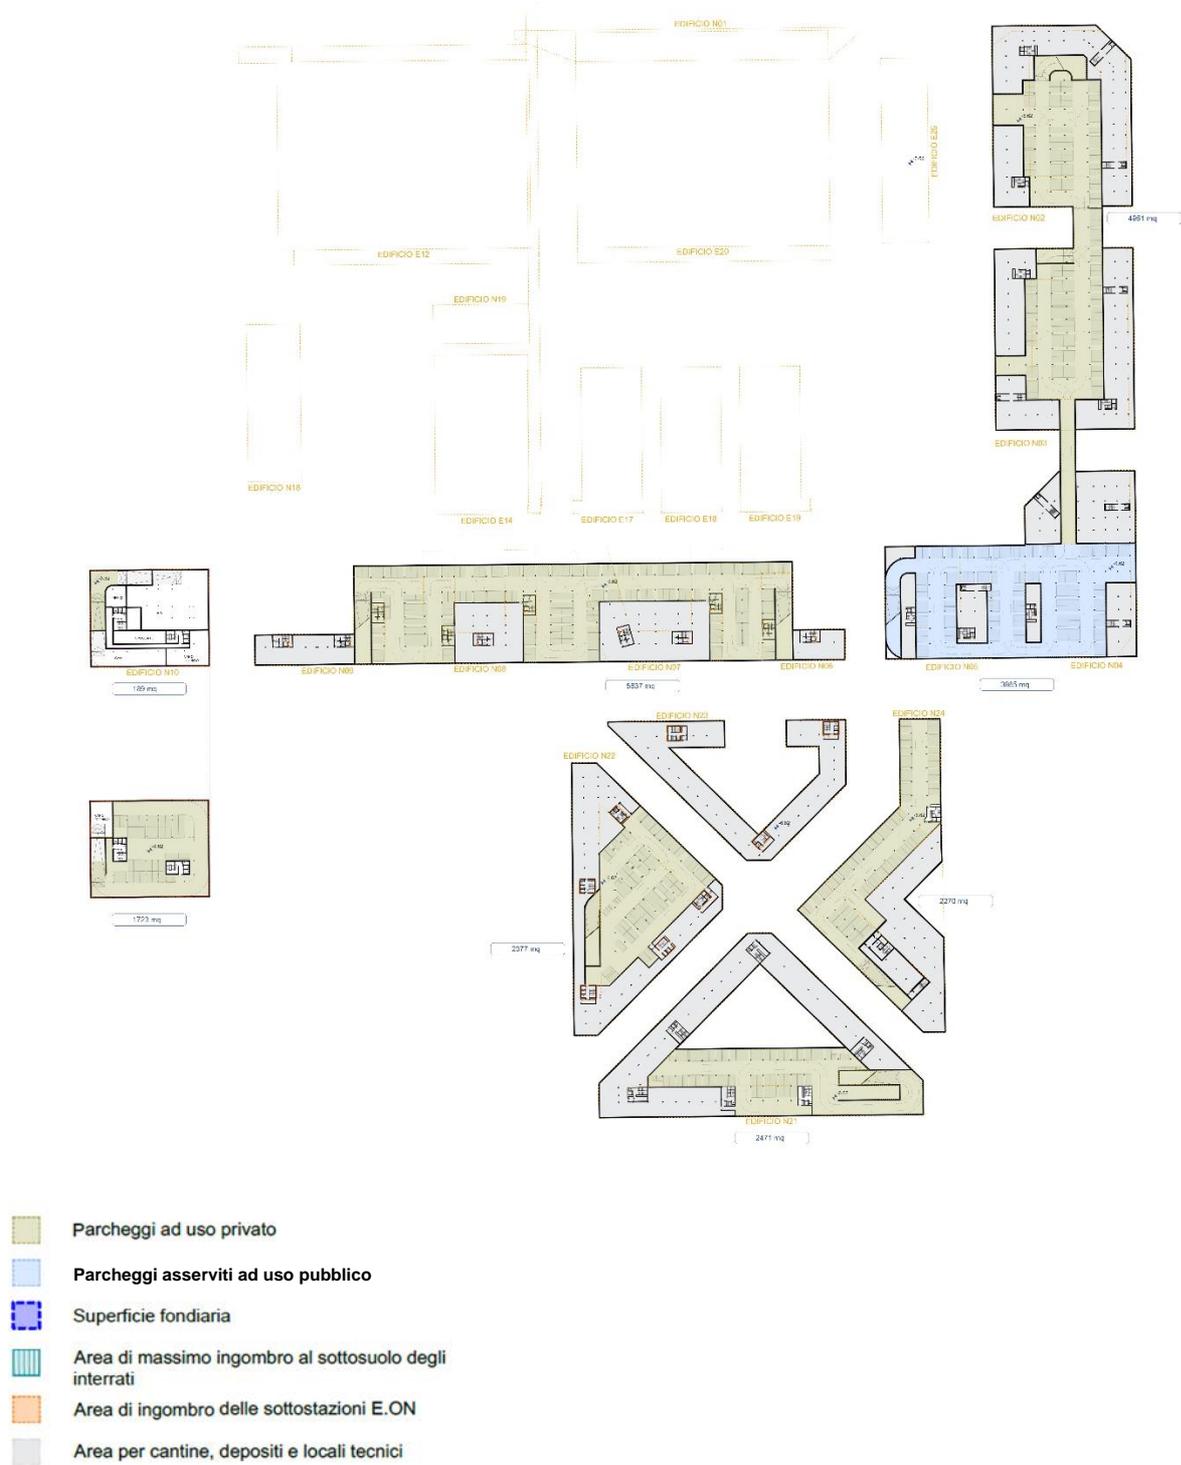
28. Planimetria piano secondo interrato - Parcheggi privati e asserviti al pubblico
